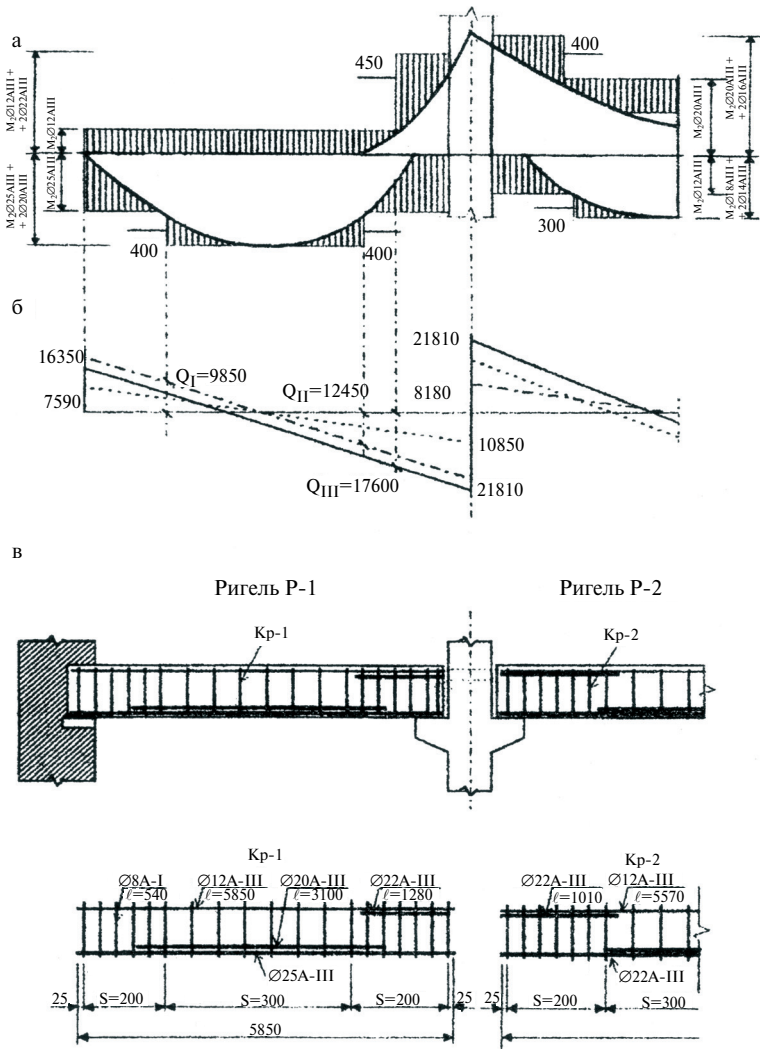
Эпюры материалов (а), эпюры поперечных сил (б) и схема армирования ригеля (в)
